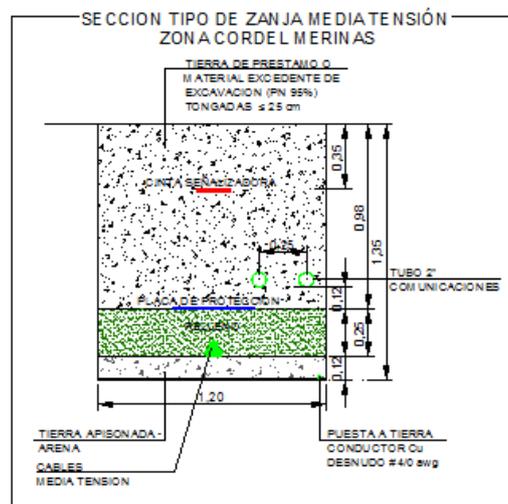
Zanja tipo LSMT
